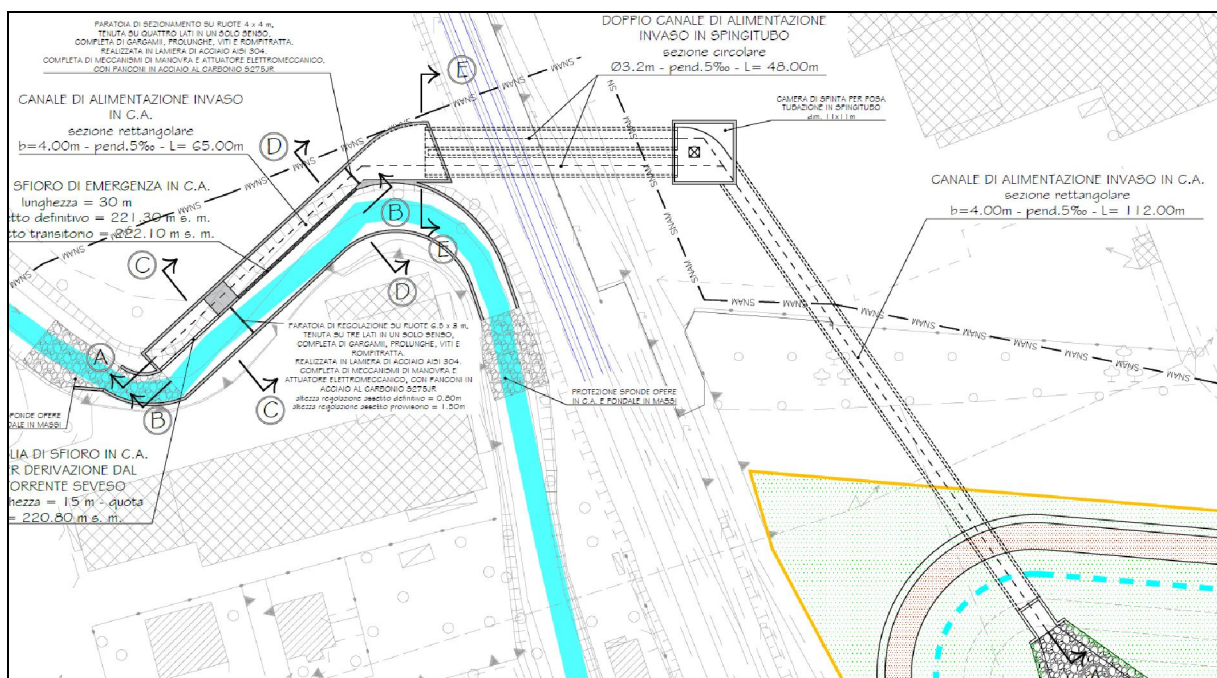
Planimetria di progetto del canale di alimentazione dell'invaso
